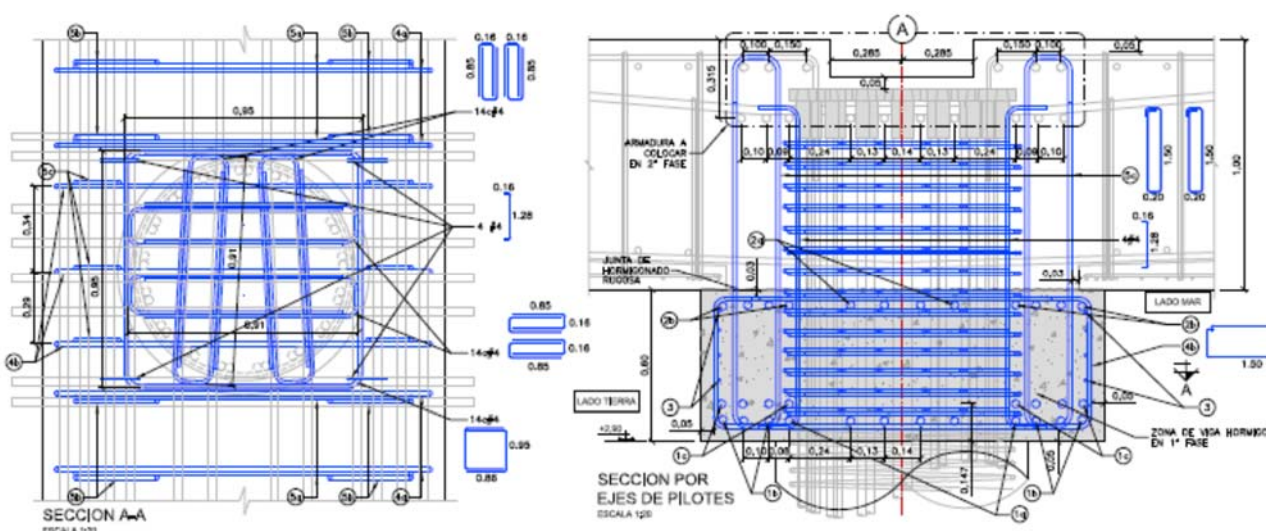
, 7b. Vista en Planta y en sección transversal de un nudo tipo pilote-losa.
